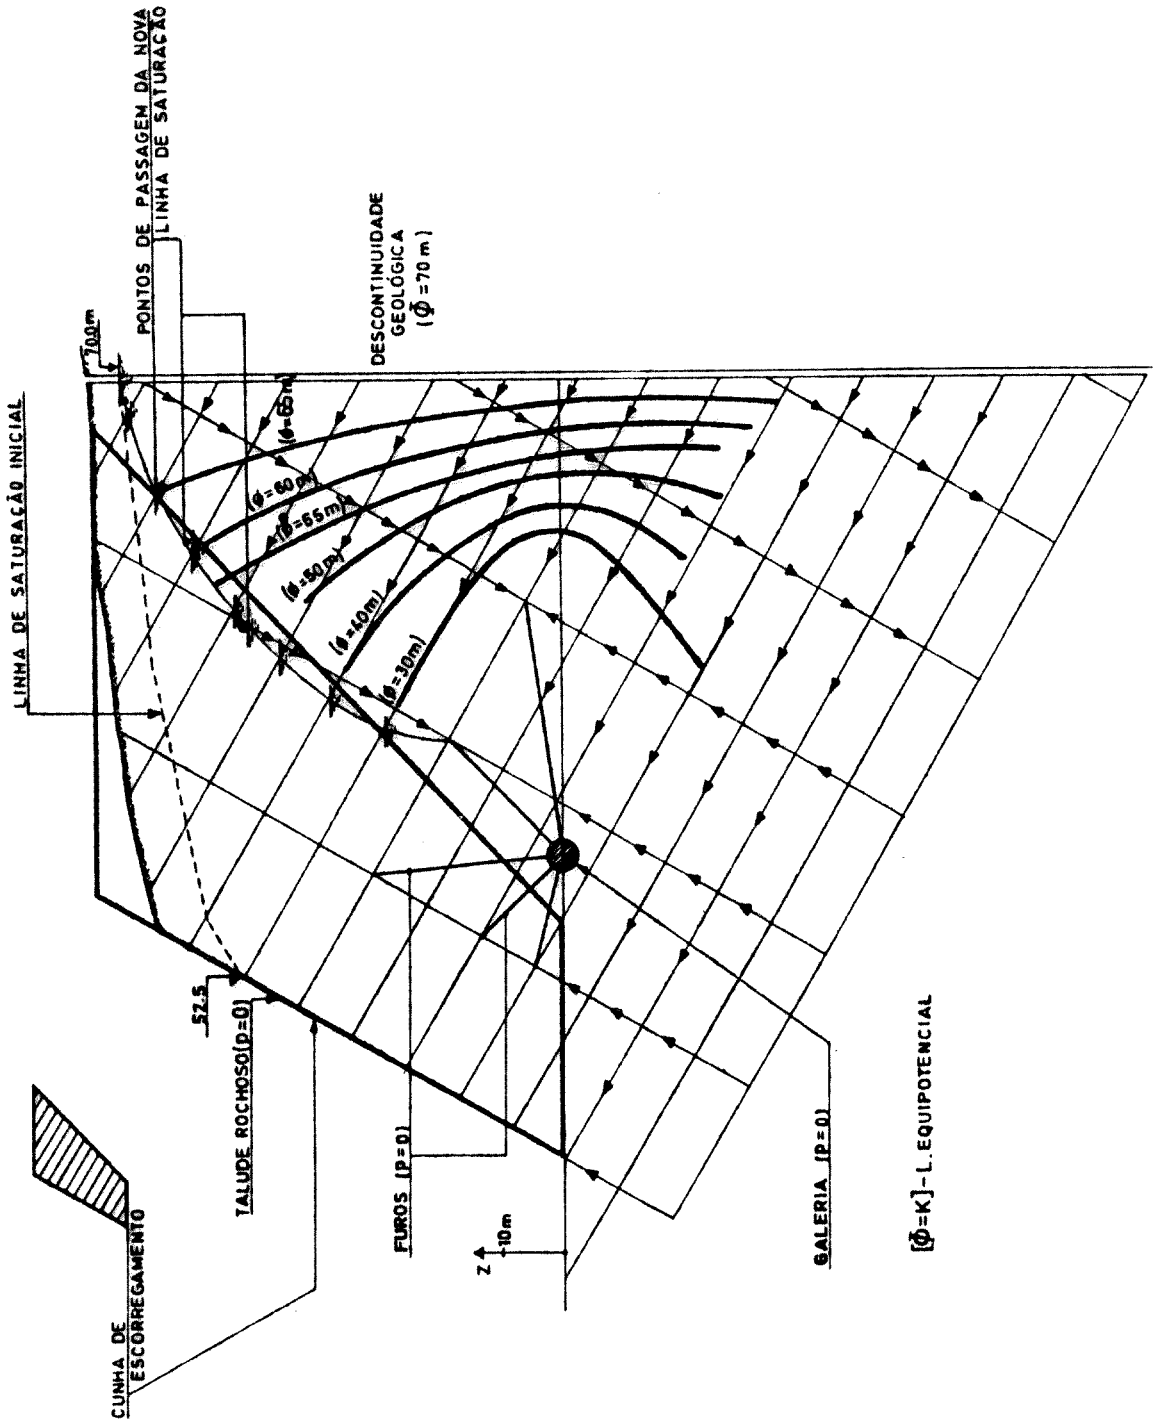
Drenagem do talude rochoso fissurado utilizando uma galeria e furos. Fácies do escoamento.
